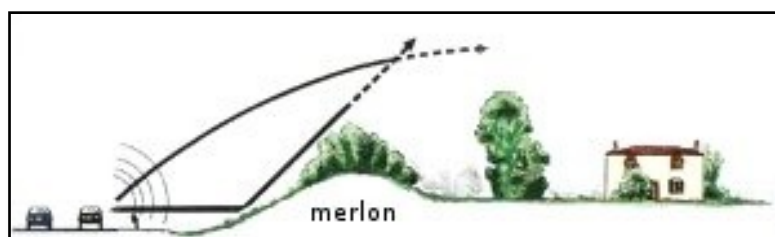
Illustration du principe d'un merlon (Source : groupe-ect.com)
